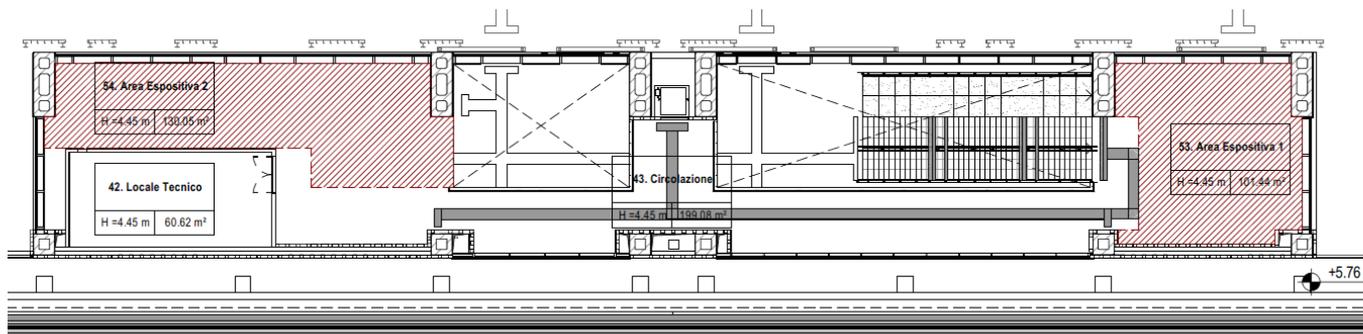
Pianta piano mezzanino con individuazione aree espositive
